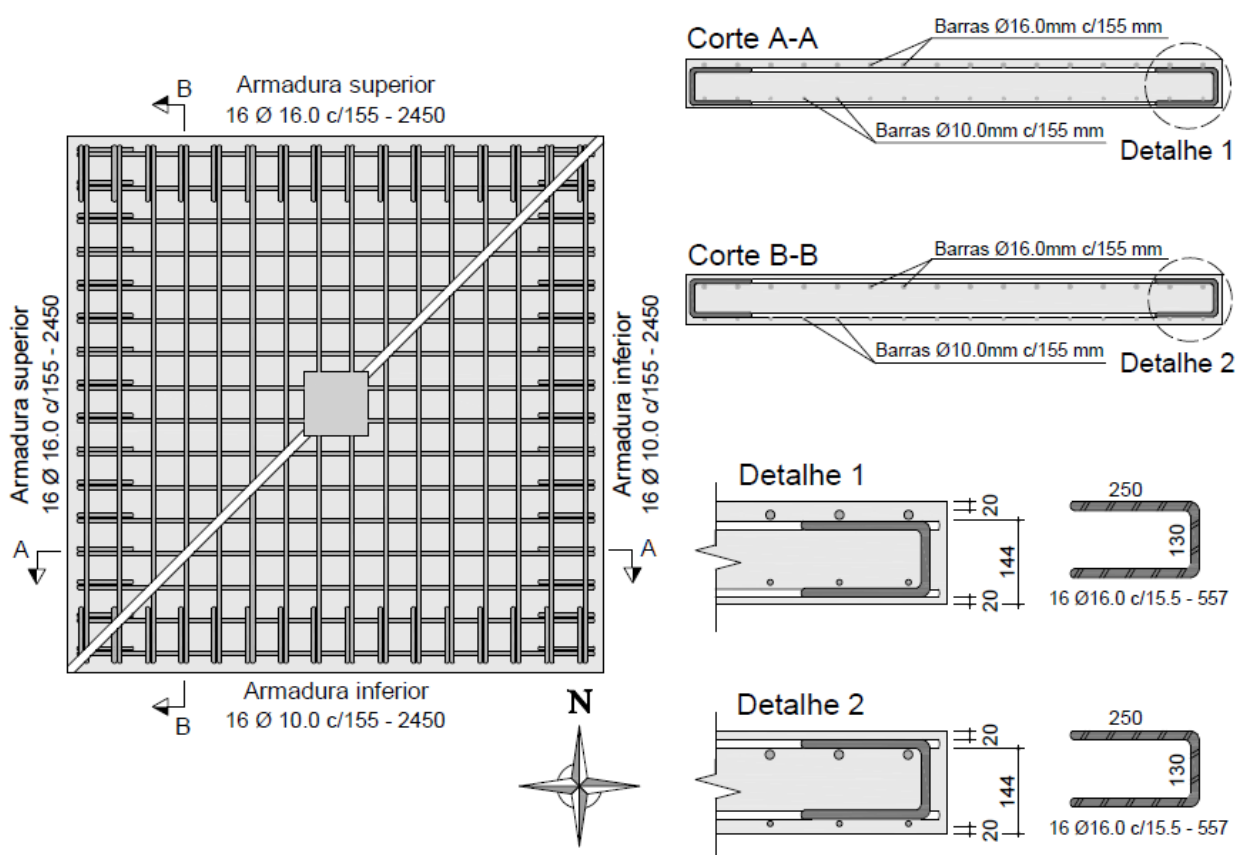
Detalhamento das armaduras longitudinais (unidades em mm)
